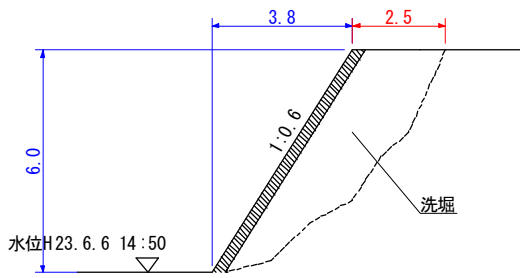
堤体断面図 (No.12, 甲子川左岸, 矢ノ浦橋付近, 図-16 中の 222, 単位 m)
